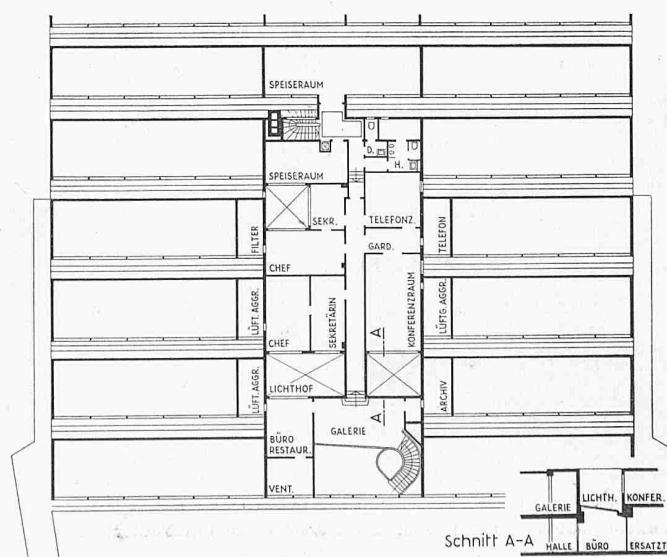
(links). Grundriss des Obergeschosses 1:600
